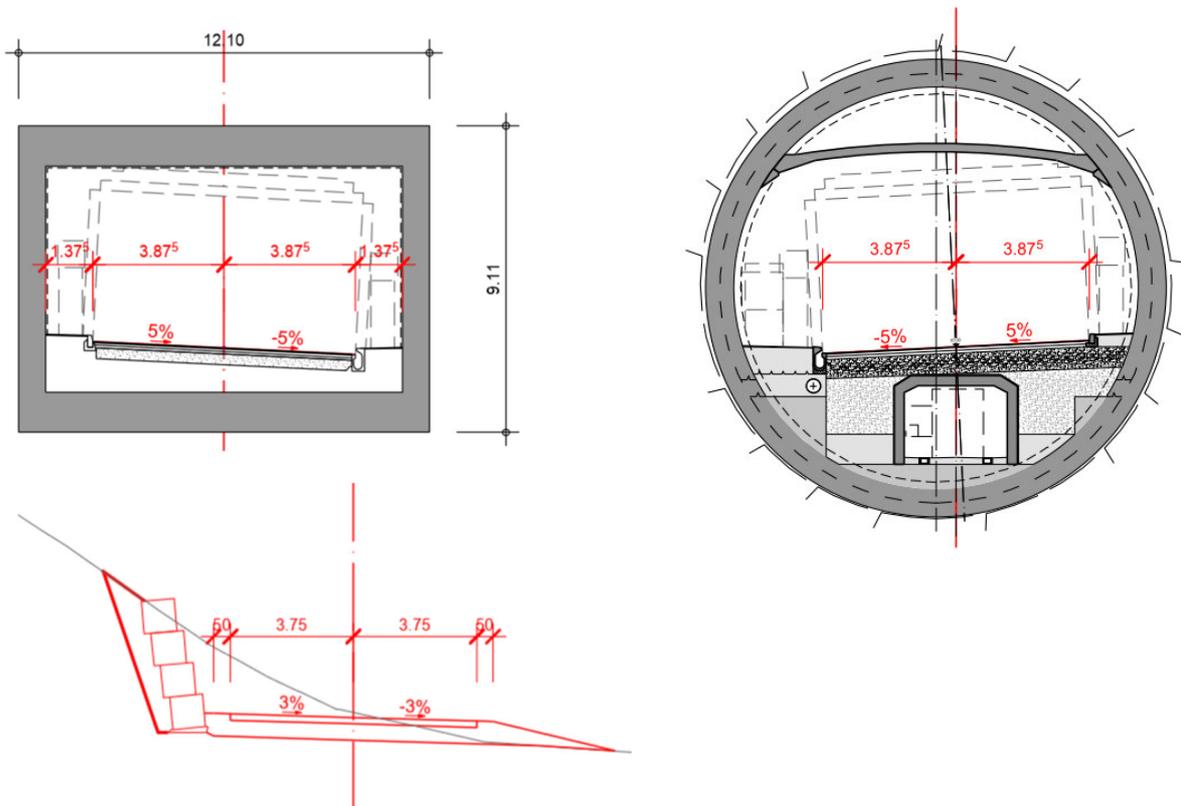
Normalprofile Tunnel und offene Strecke Quelle: Eigene Darstellung)
